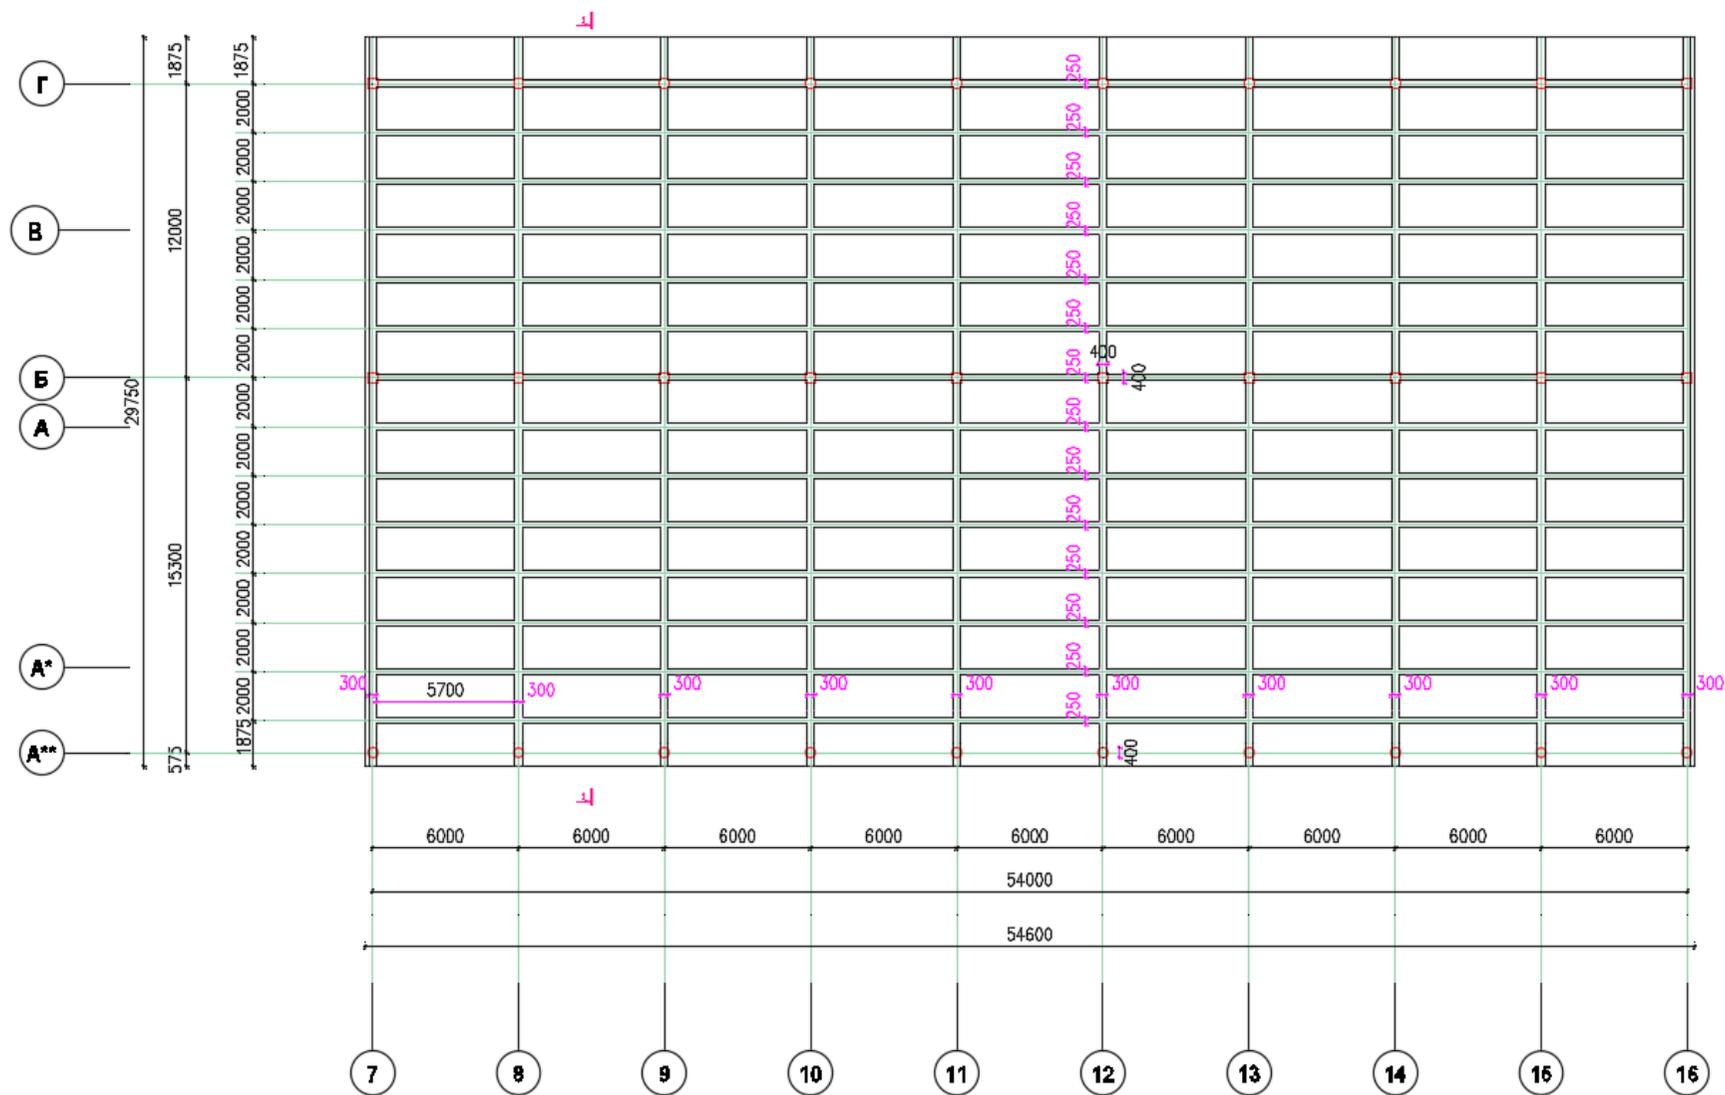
План монолитного ребристого покрытия с балочными плитами
